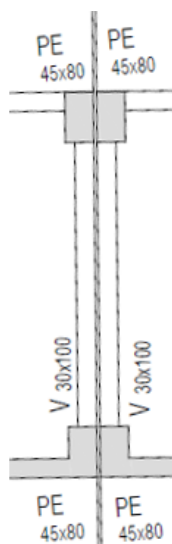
DETALHE TÍPICO DOS PILARES - EIXOS E4, E6, E14 E E16
